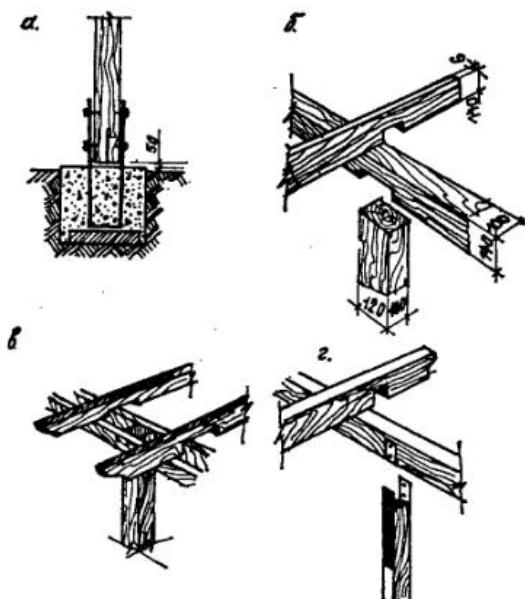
Конструктивные узлы перголы: а — бетонирование стойки в землю; б — крепление верхней обвязки к стойке; в — крепление стропил к верхней обвязке; г — крепление верхней конструкции при помощи металлических полос.
